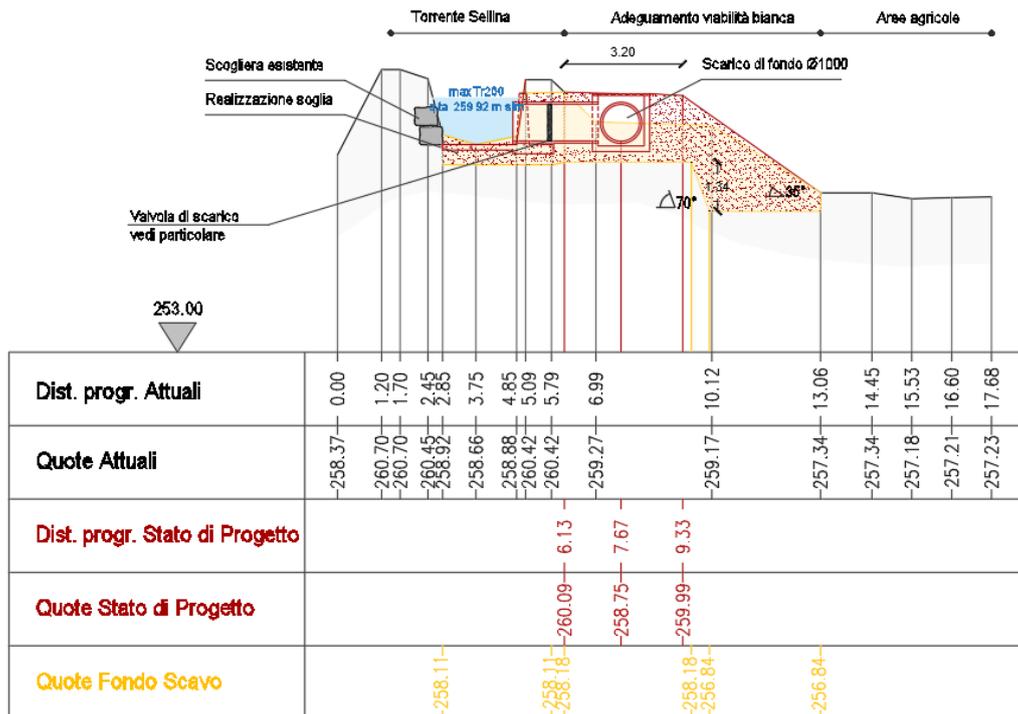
estratto della tavola T03b del progetto - Sezione 1038
